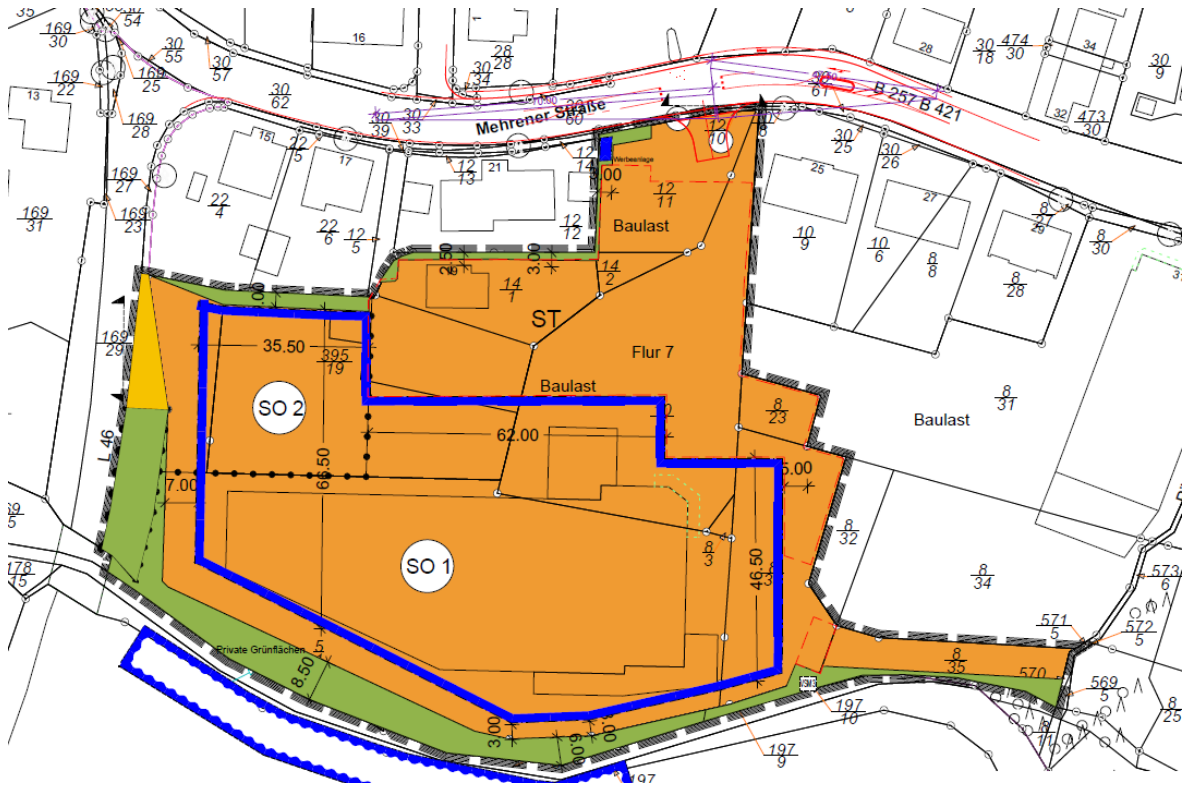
Bebauungsplan „Auf Meiland/Unterste Brühl“, Quelle WeSt-Stadtplaner GmbH
